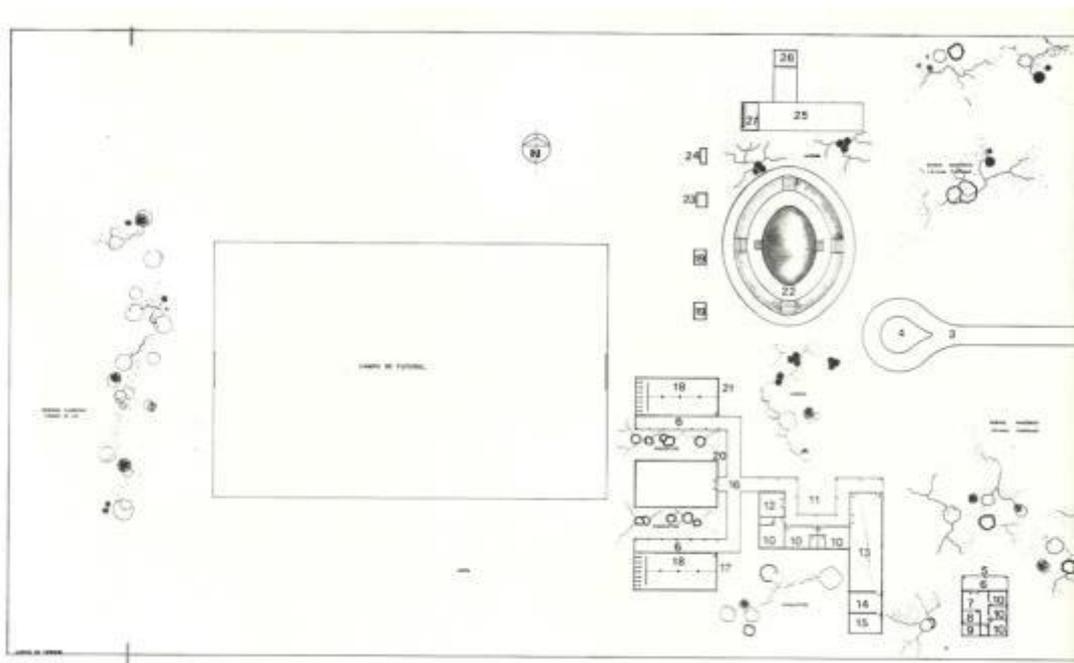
Planta de implantação do Retiro Tagaste. Fonte: Revista Projeto nº102.
